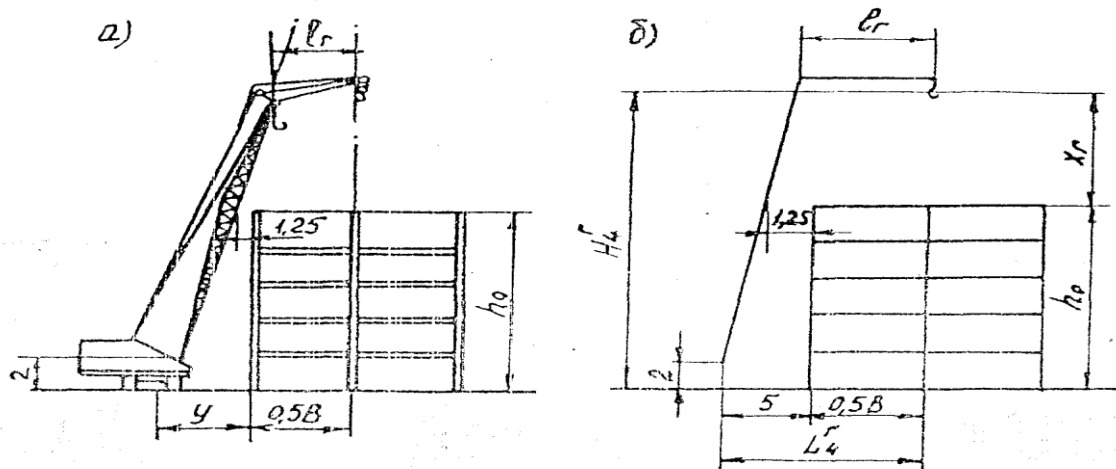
Схема монтажа жилого здания самоходным стреловым краном, оборудованным стрелой с гуськом:
